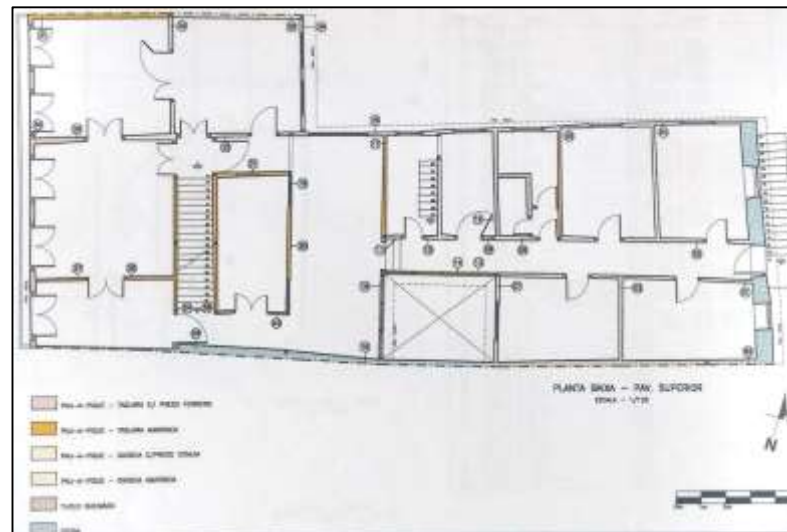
Planta baixa do pavimento superior da Casa da Baronesa, com identificação dos materiais.
